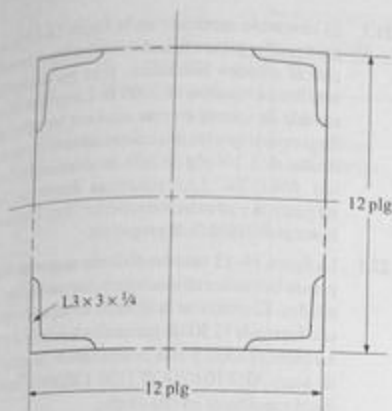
Sección transversal de columna compuesta del problema 14-13.
